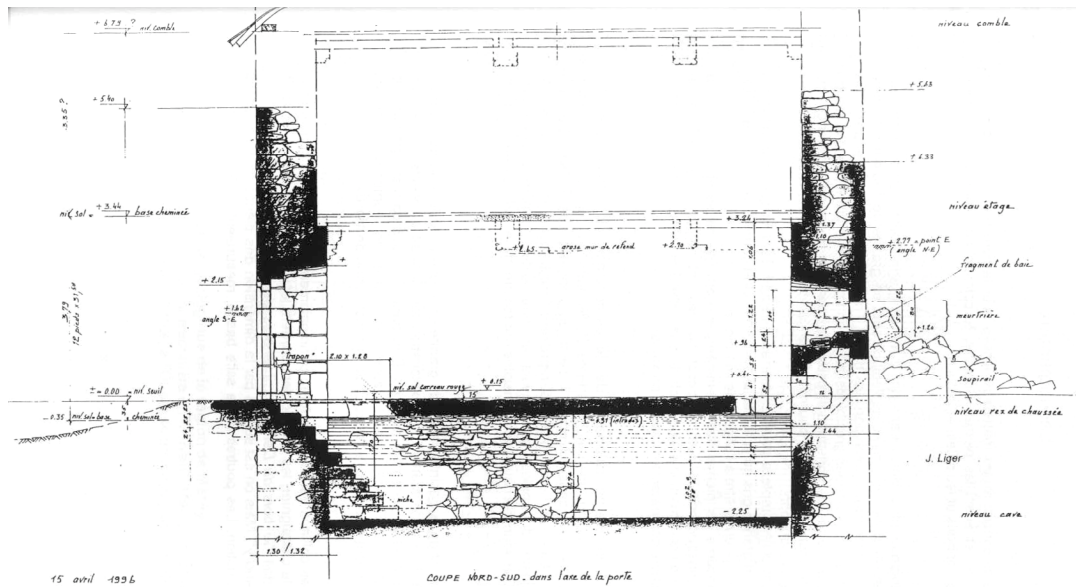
Coupe nord-sud de la construction dans l'axe de la porte.
